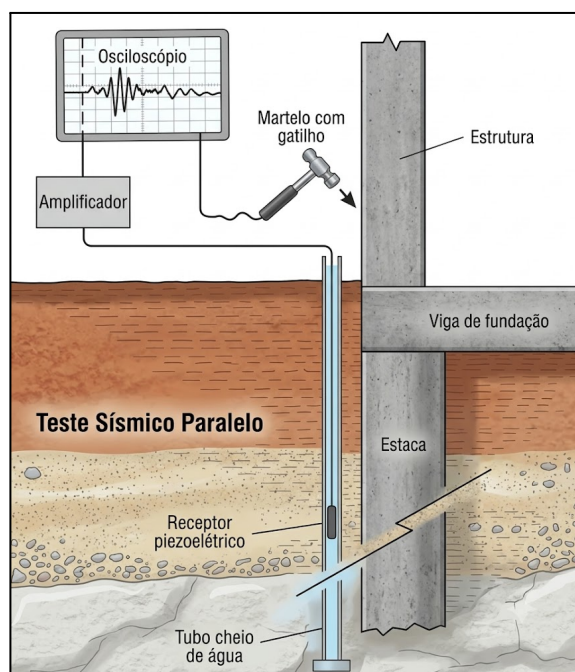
Esquema do ensaio sísmico paralelo para avaliação de fundações existentes (Adaptado de Hertlein e Walton, 2000).
